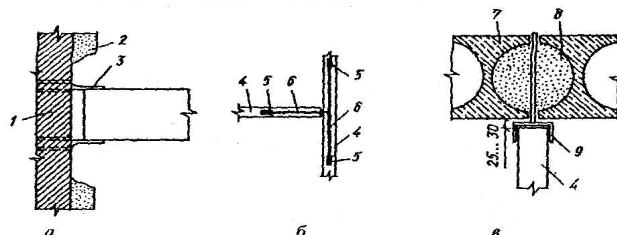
Вузли кріплення гіпсопрокатних перегородок: а – до капітальної стіни; б – до суміжної перегородки; в – до перекриття; 1 – капітальна стіна; 2 – штукатурка; 3 – анкер; 4 – панель перегородки; 5 – монтажна петля; 6 – скрутка із дроту; 7 – панель перекриття; 8 – цементно-піщаний розчин; 9 – металева закладна деталь
